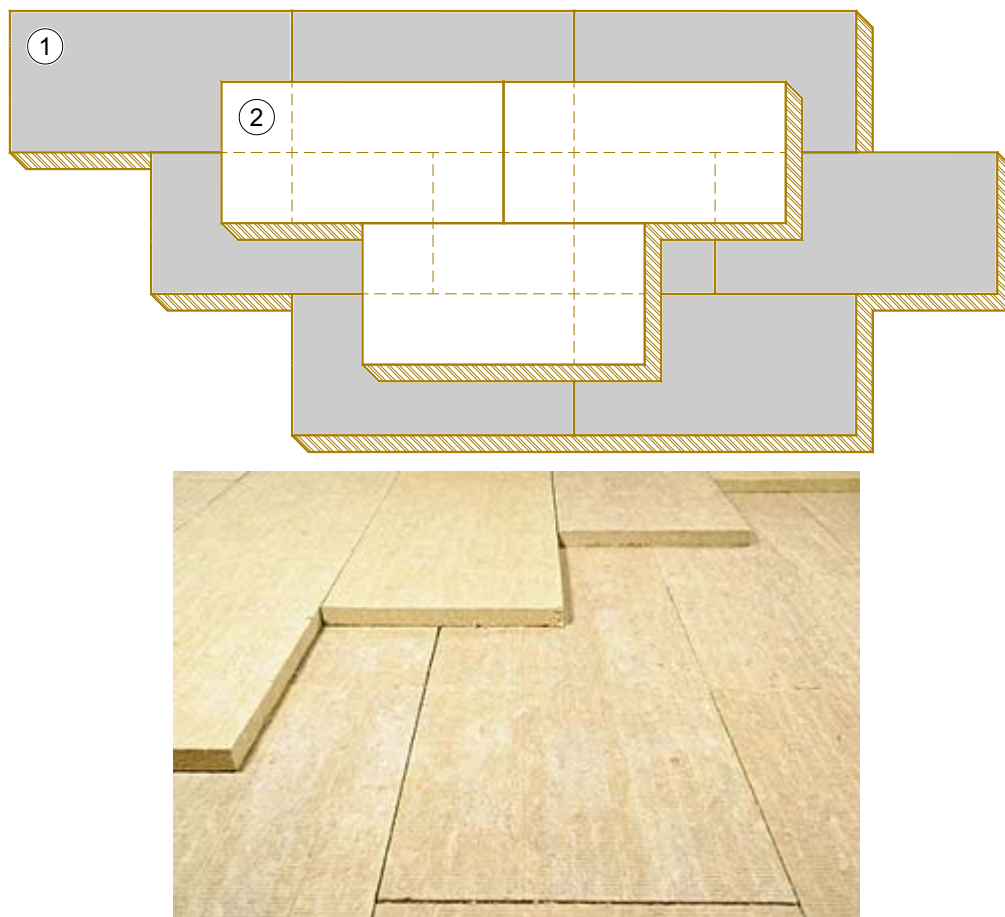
Укладка плит среднего теплоизоляционного слоя
